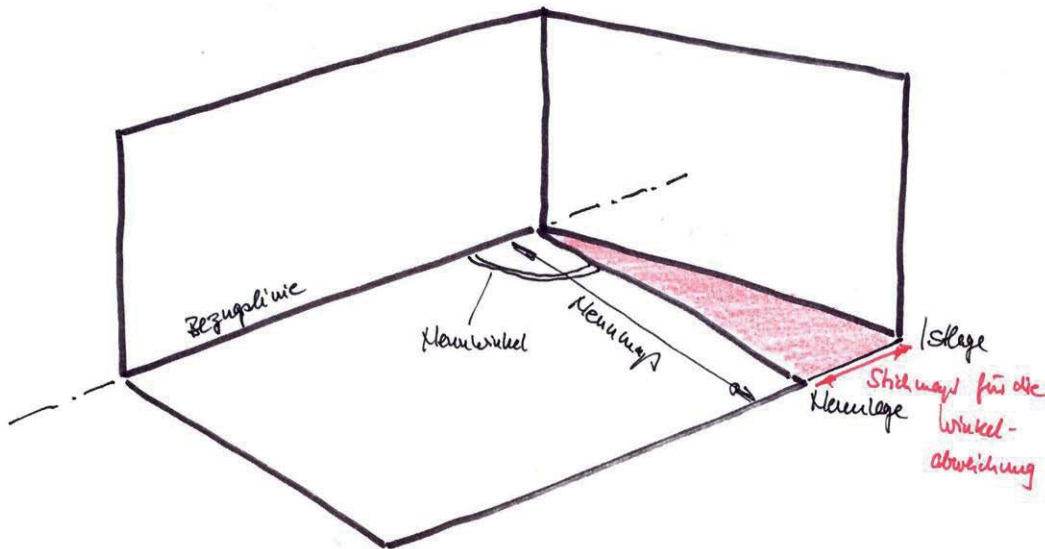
Prüfung eines Winkels im Grundriss
